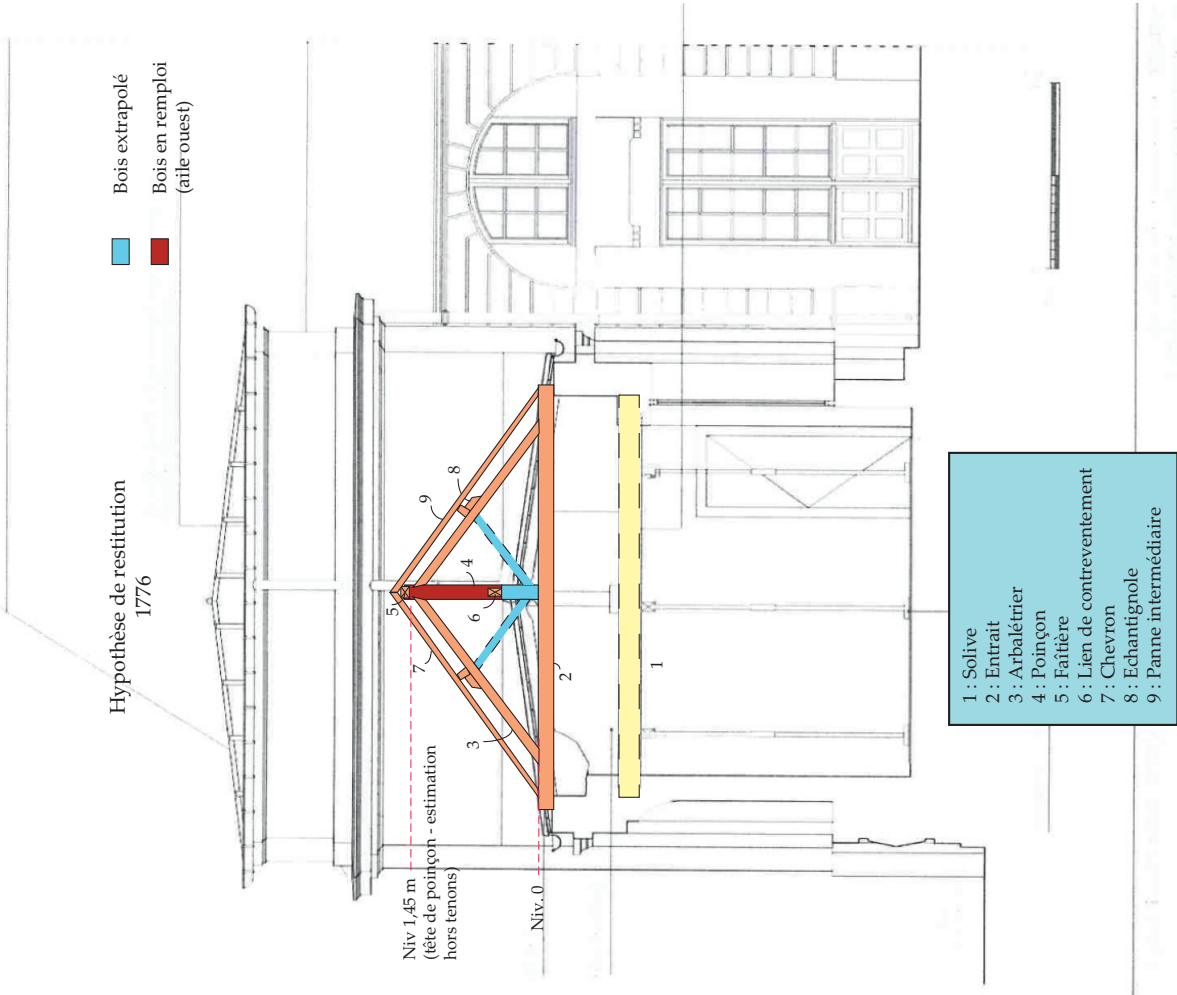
Coupe longitudinale. Relevé de l'agence Caillaud, 2025.
